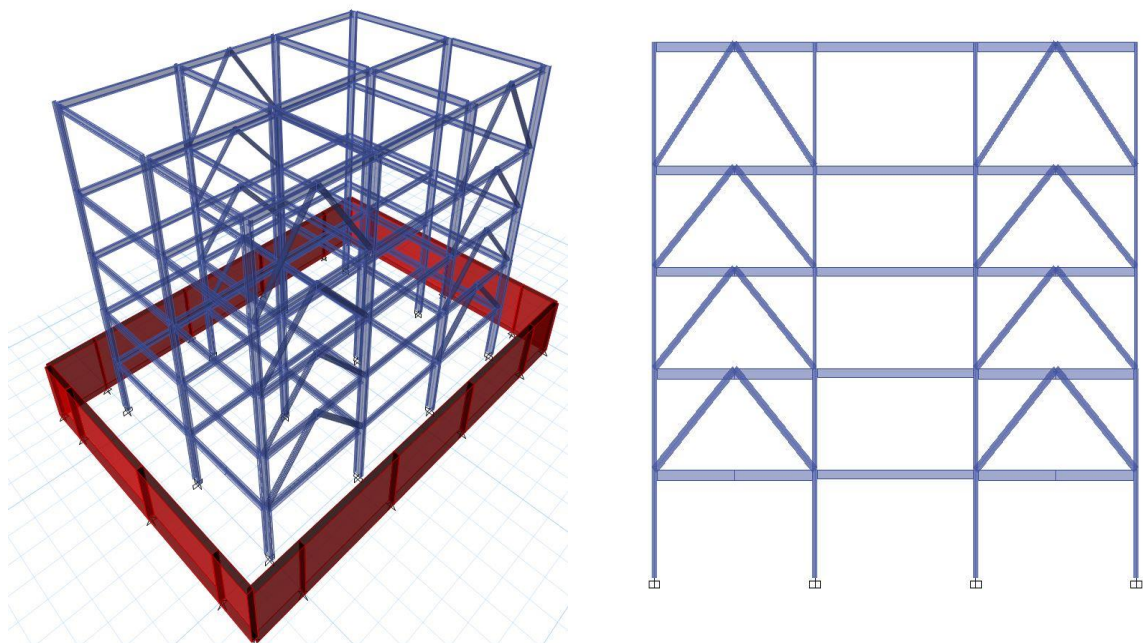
Estructural principal del edificio y detalle de un plano estructural o elemento.
